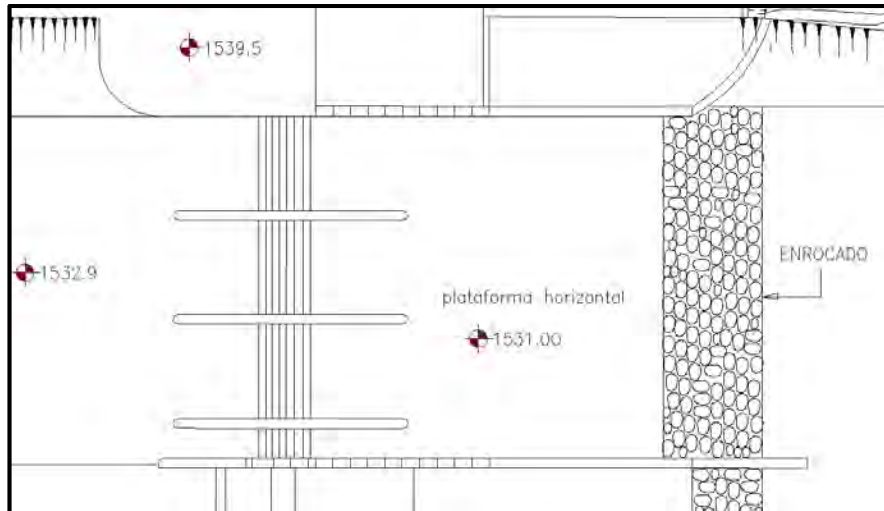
Vista en planta del diseño definitivo de barraje móvil.
